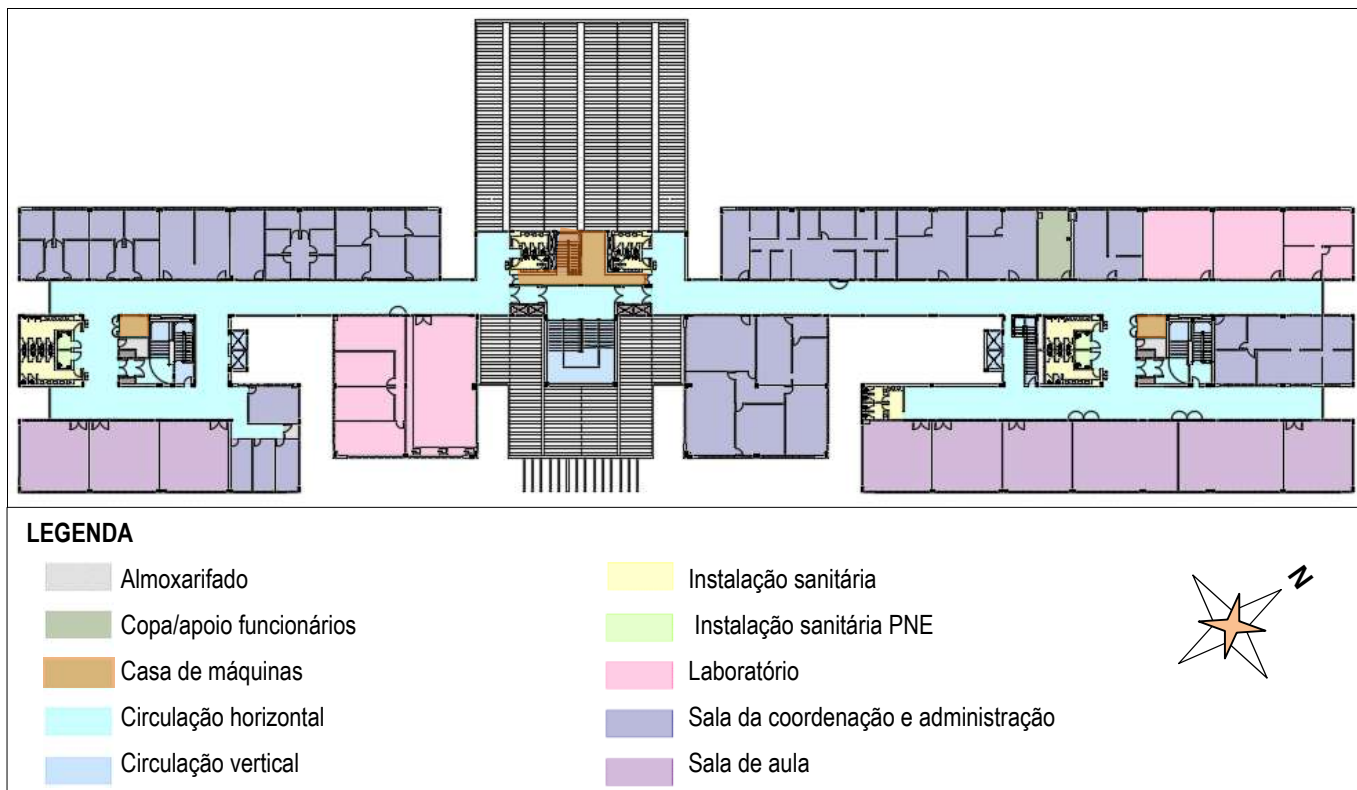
Planta setorizada do terceiro pavimento do bloco 04.
